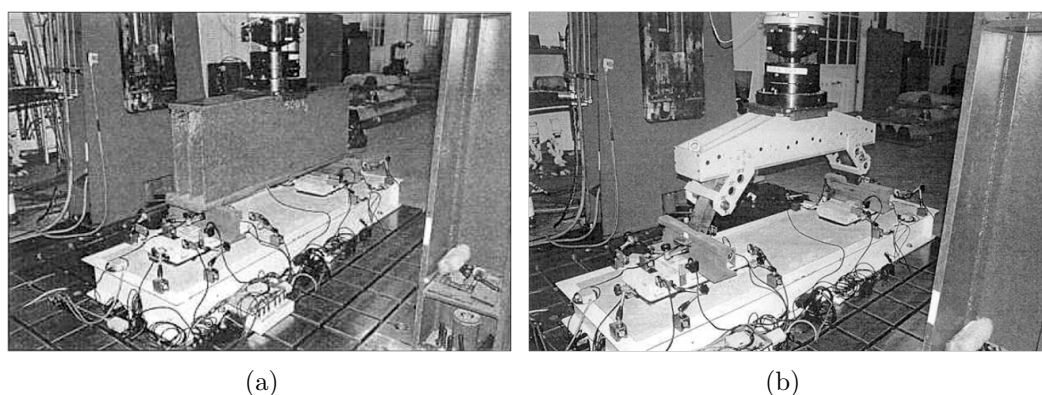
Essais statique et dynamique d'une voie assemblée avec poutre horizontale (a) et bielle inclinée (b)
